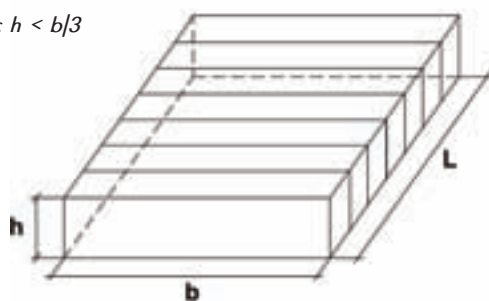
Деление кровли на зоны ветровой нагрузки.
